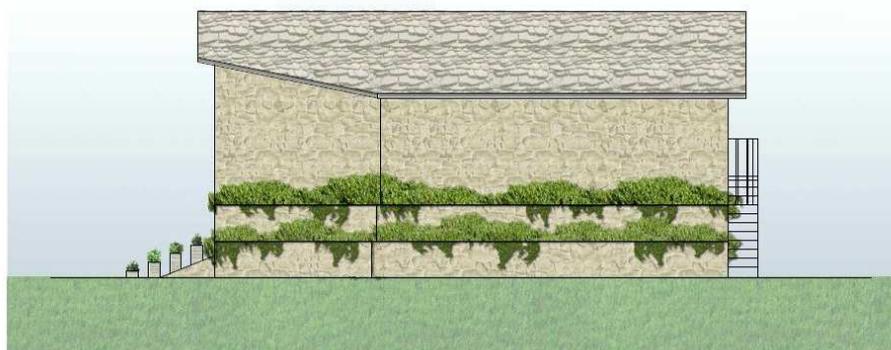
Vista da zona laghi_ Estratto Elaborato 016 Piante, sezioni e prospetti della centralina
